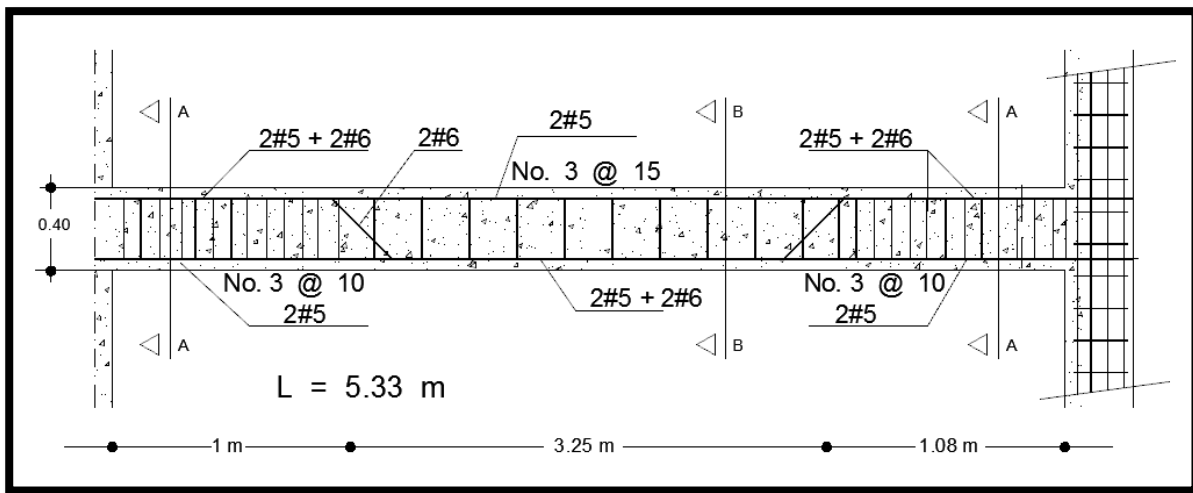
Viga E2 del pórtico A2-B2, Cuerpo 1.
